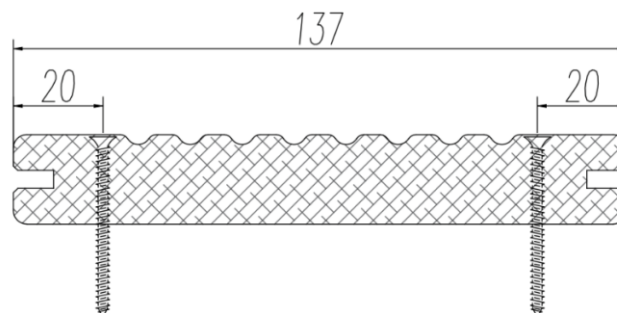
Positionnement des fixations des lames par vissage - coupe transversale sur lames de platelage
